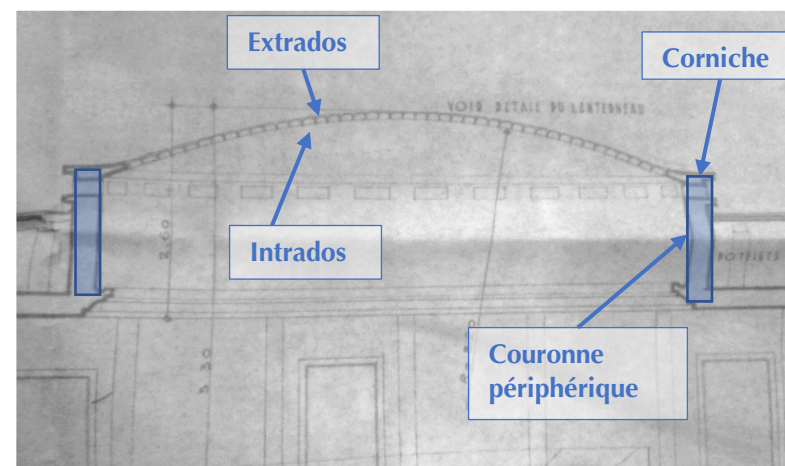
Nomenclature du dôme, fond de plan architecte, image d'archive
